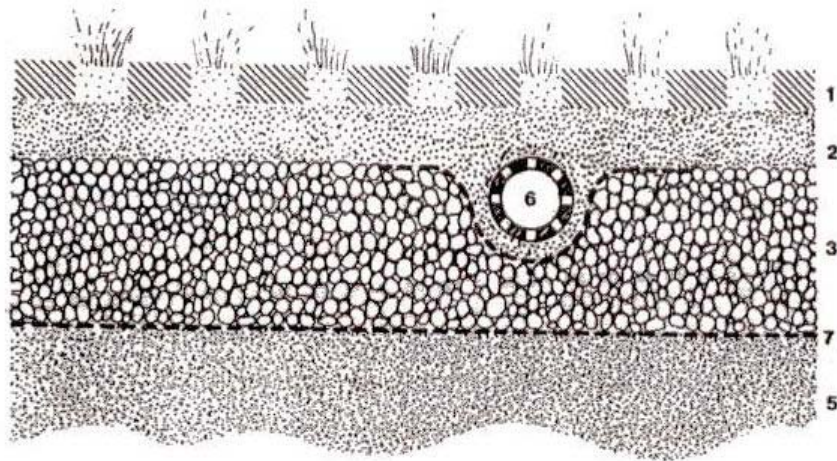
Drenes en un pavimento filtrante. 1 a 7 como en la Figura 4.2.5.8.
